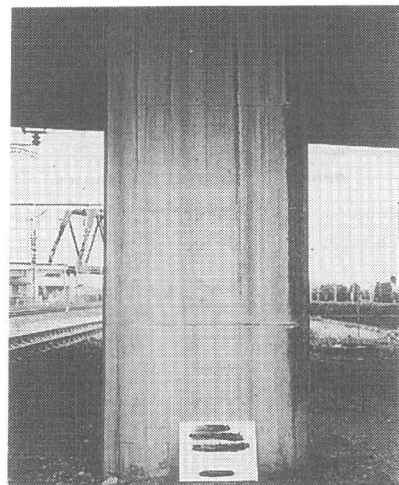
RC橋脚の輪切り状ひび割れの例
